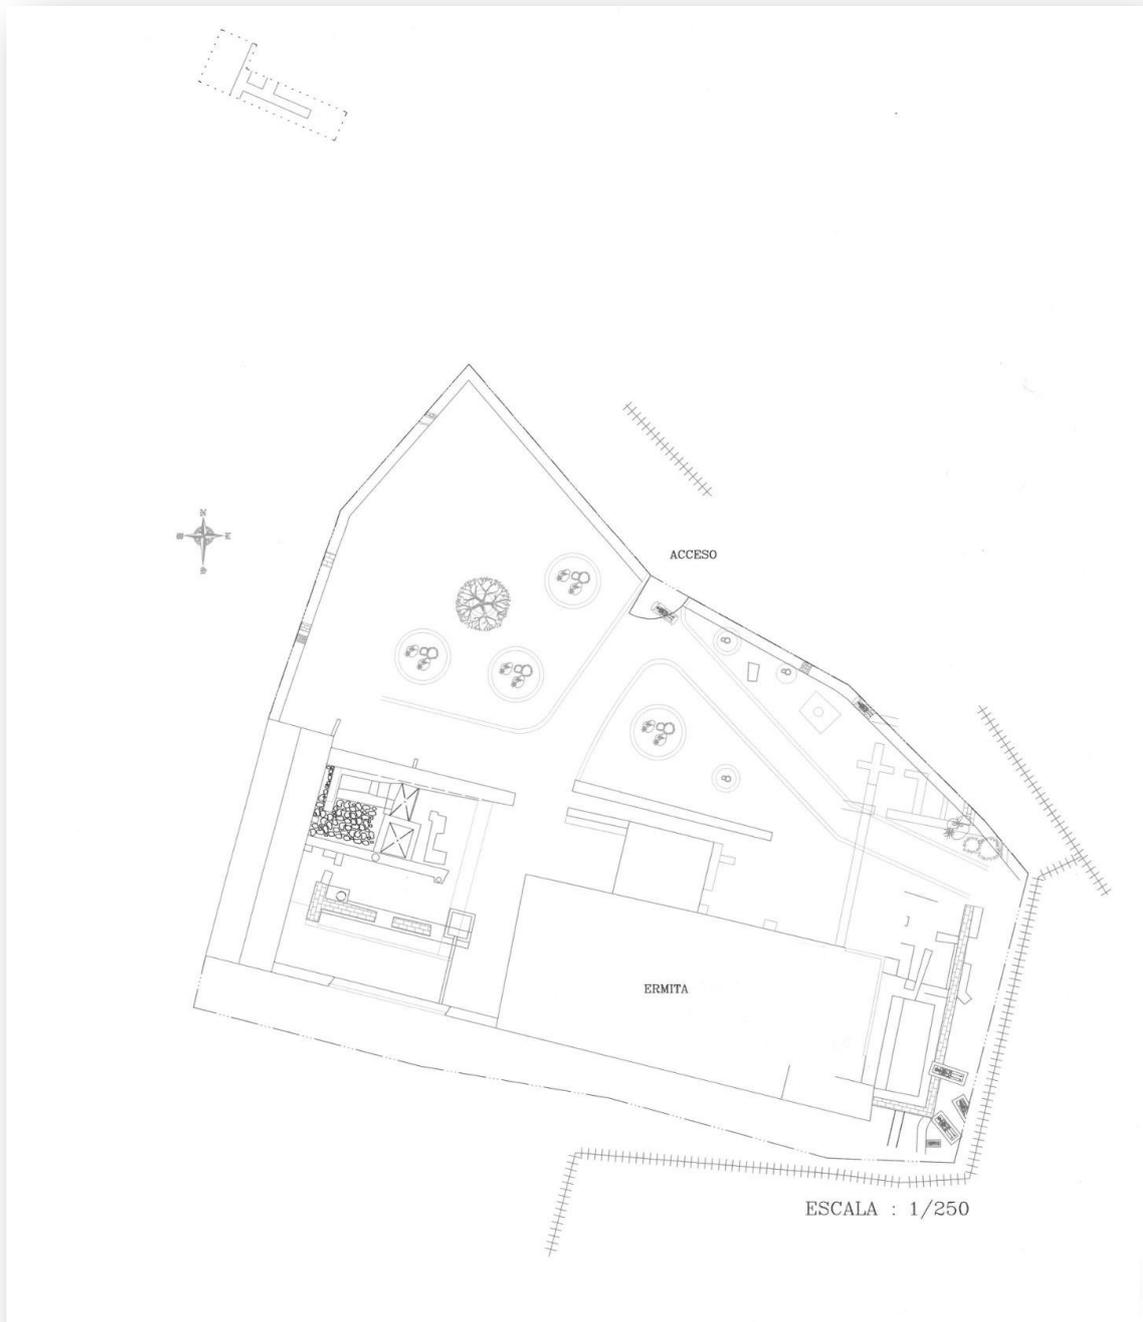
Plano de la Ermita de San Ambrosio, con todas las estructuras constructivas halladas.
